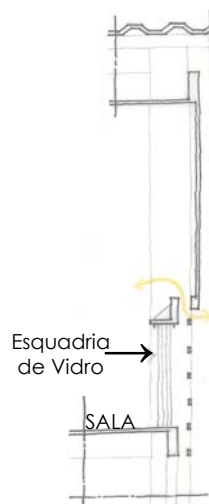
Casa U1.2 – Princípio do peitoril ventilado.
